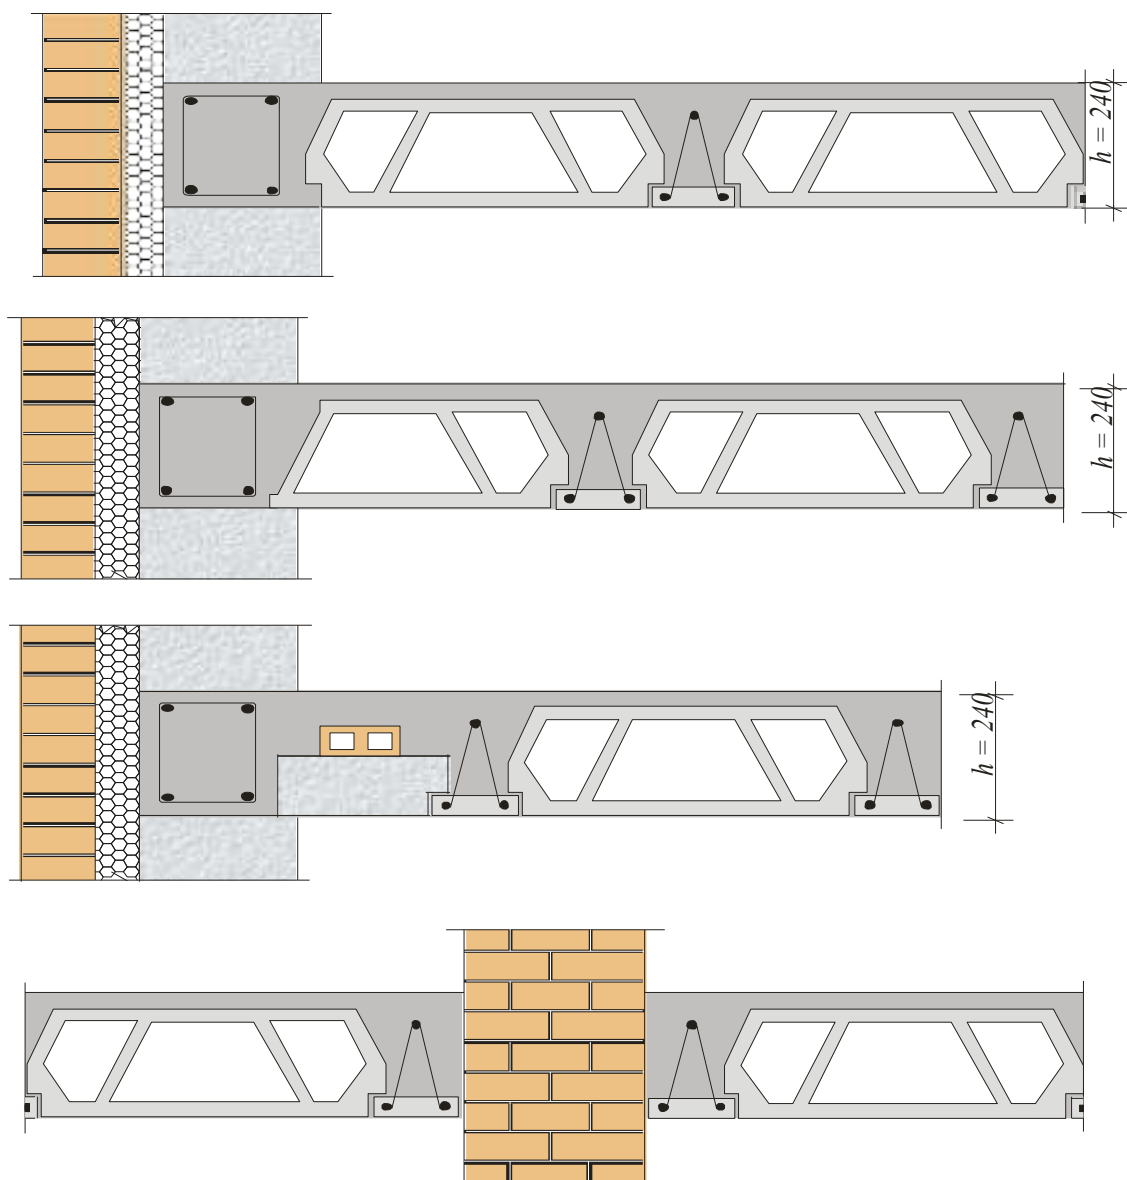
Способы укладки пустотелых блоков к стенам, параллельных балкам.
